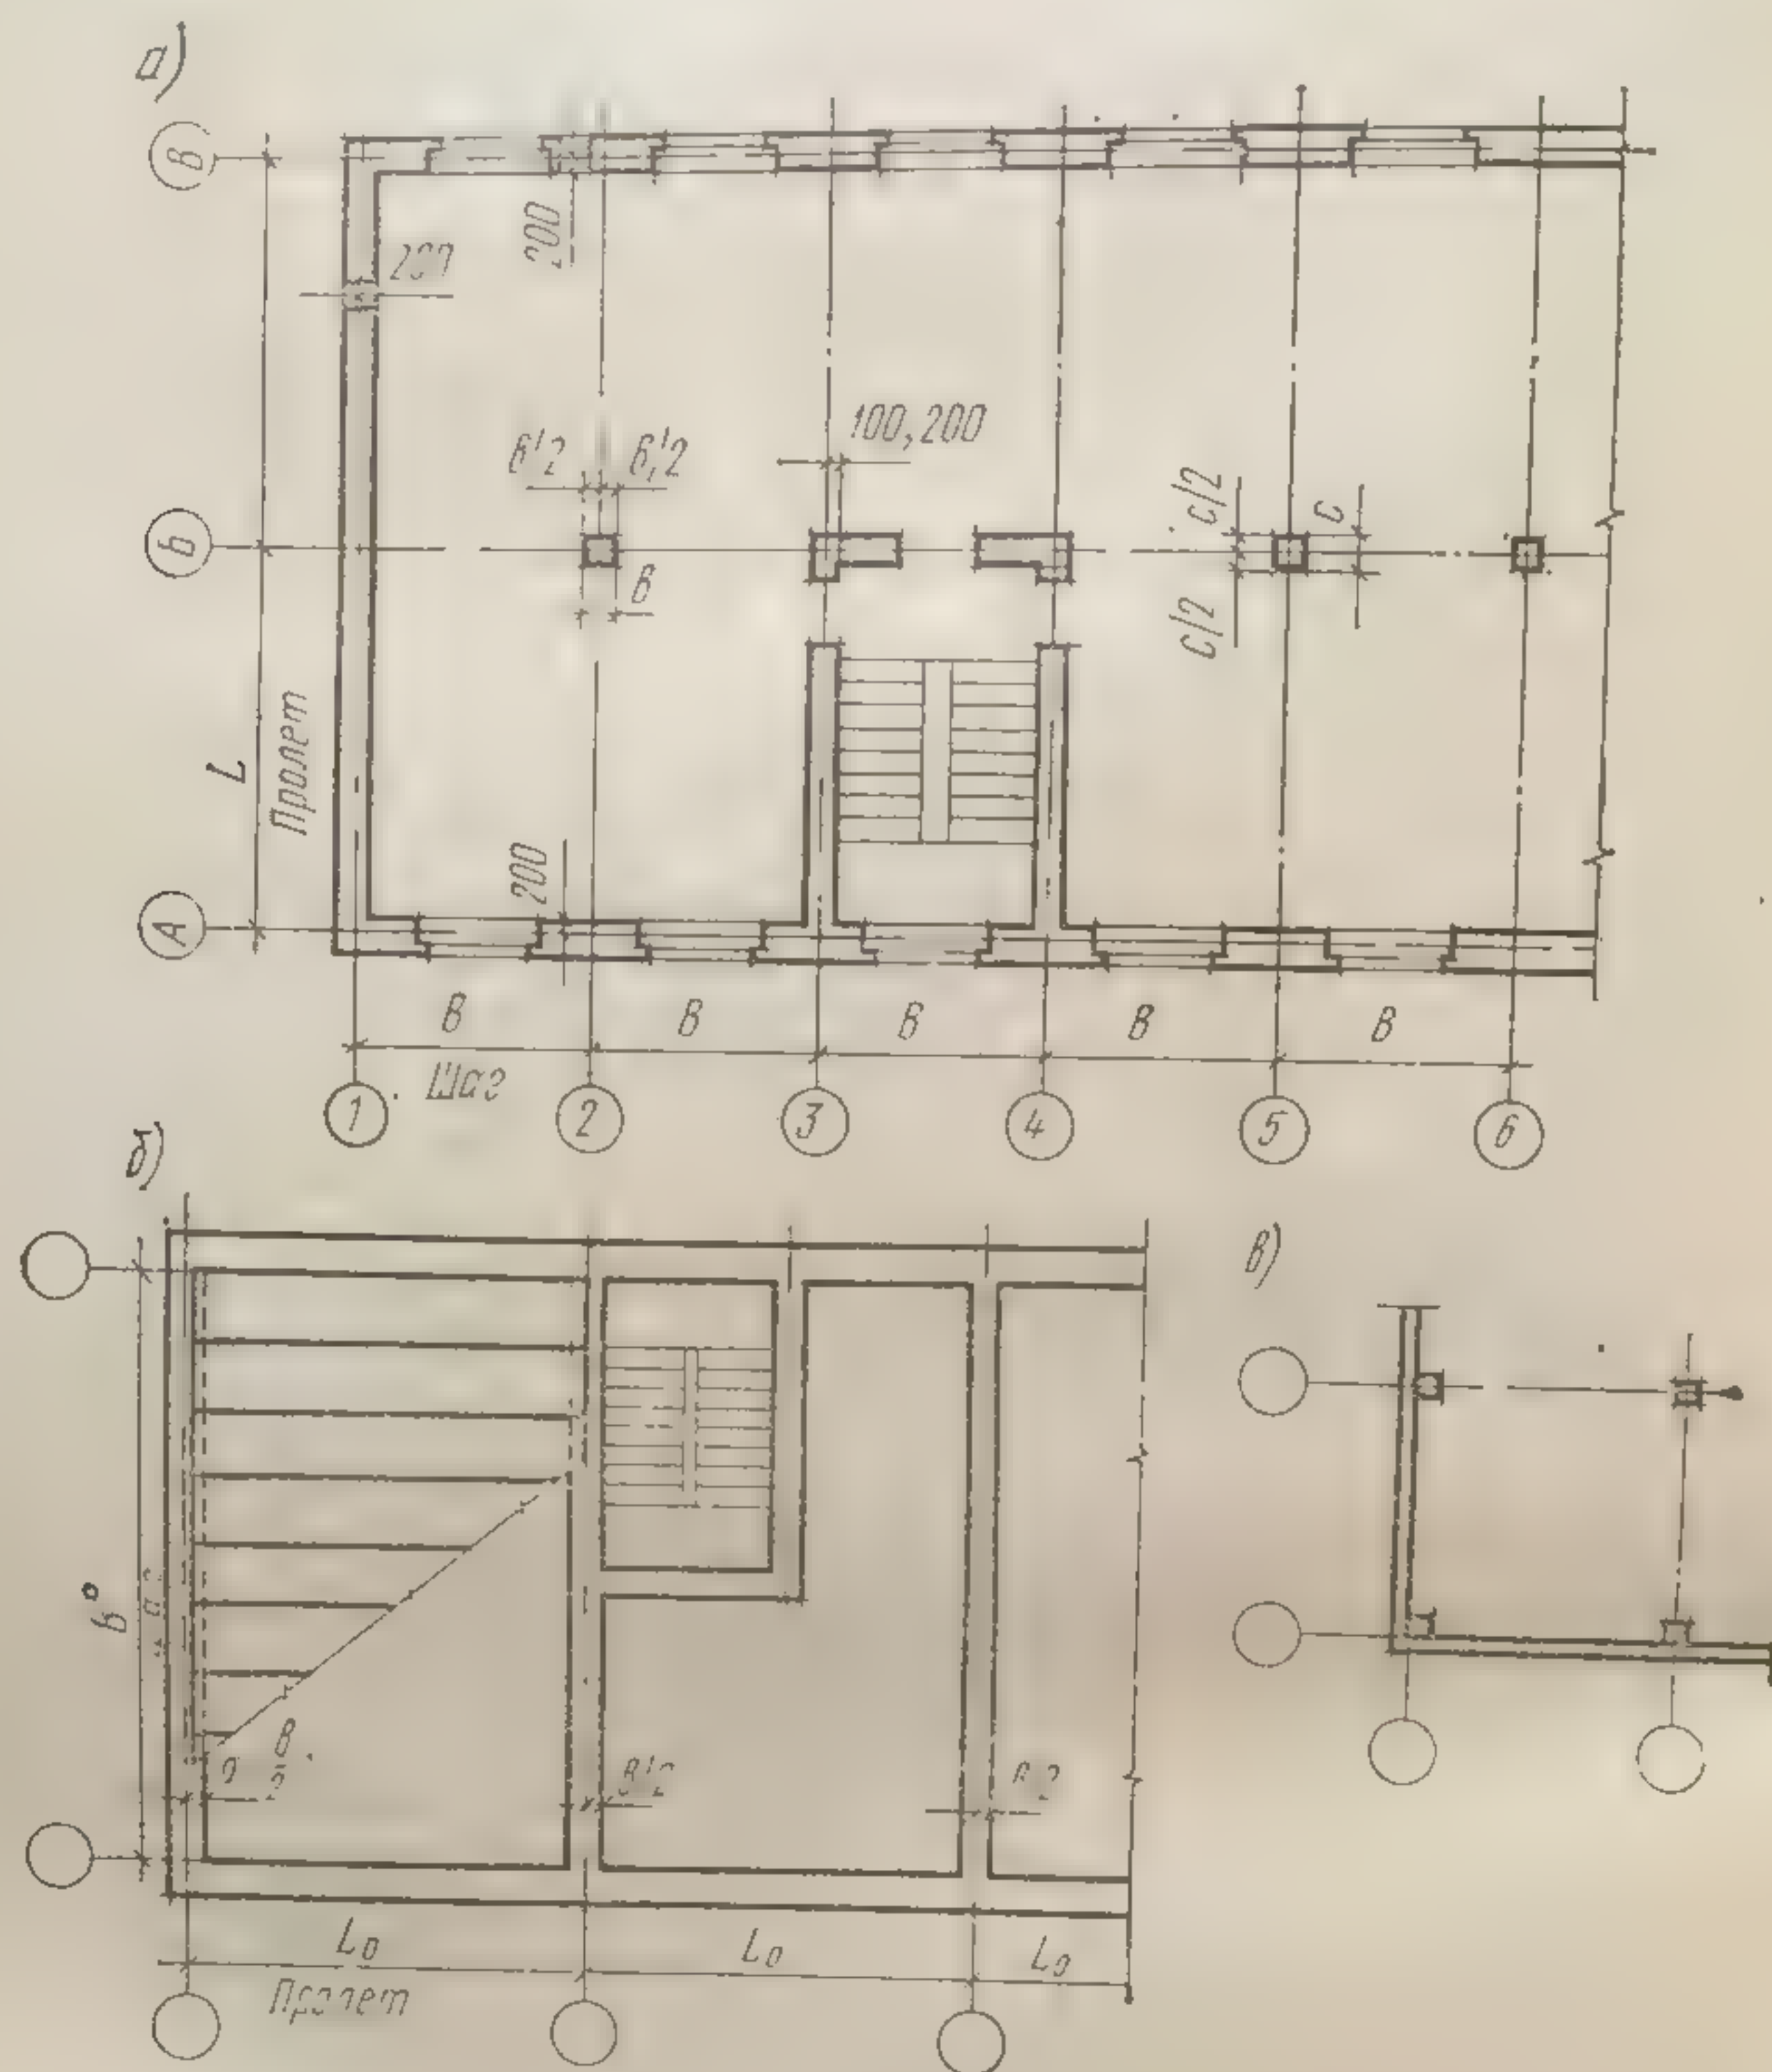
Расположение разбивочных осей в плане здания и привязка к ним стен и отдельных опор:
